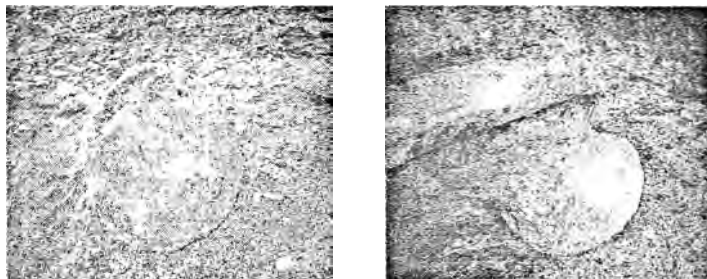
Общий вид раскопанной уширенной пяты свай, выштампованной из сухой бетонной смеси в песке (на левом снимке видна пята сверху, на правом – сбоку рядом с трамбовкой)
